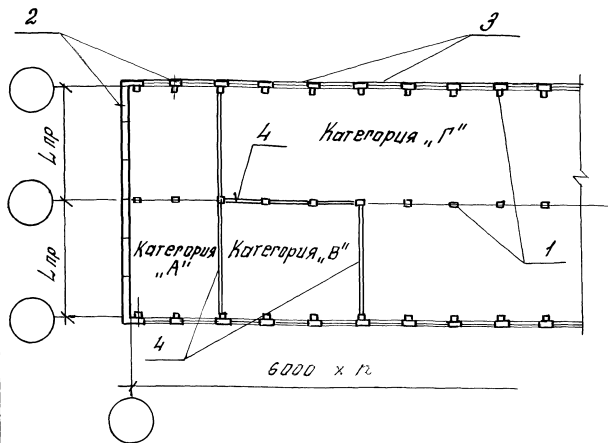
Пример расположения противопожарных перегородок в плане здания со стенами и покрытием из негорючих материалов
